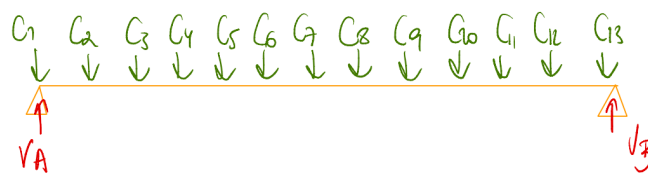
Schématisation de la poutrelle comme une poutre bi-appuyée
